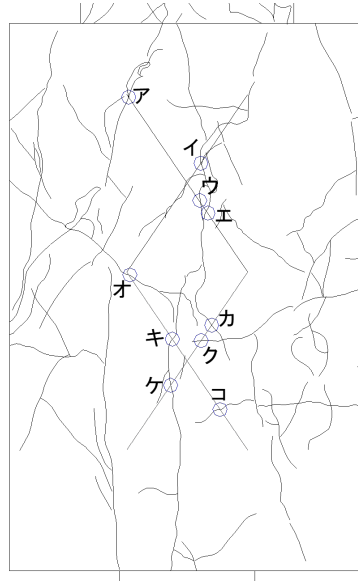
パイルキャップひび割れ幅測定位置 (試験体 A-3 正載荷)
